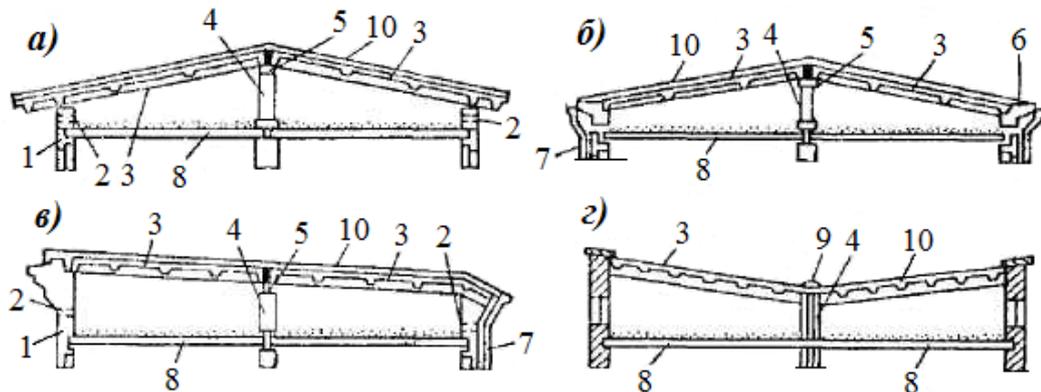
Схемы чердачных крыш жилых зданий из сборного железобетона: а – двускатная с увеличенным выносом кровельной плиты и неорганизованным водоотводом; б – двускатная с метал. желобами и организованным водоотводом; в – односкатная с организованным водоотводом; г – двускатная с внутренним водоотводом;
